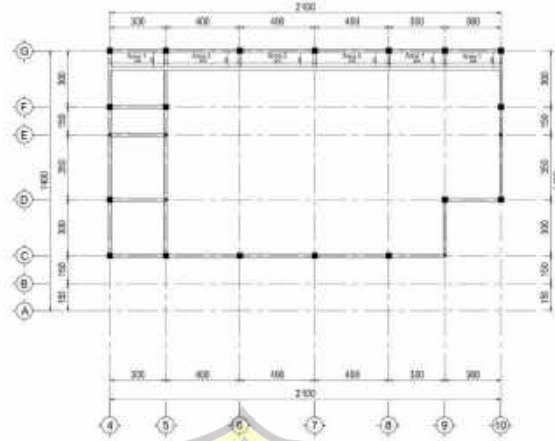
13 Denah Dag Talang ELV. 4.00
